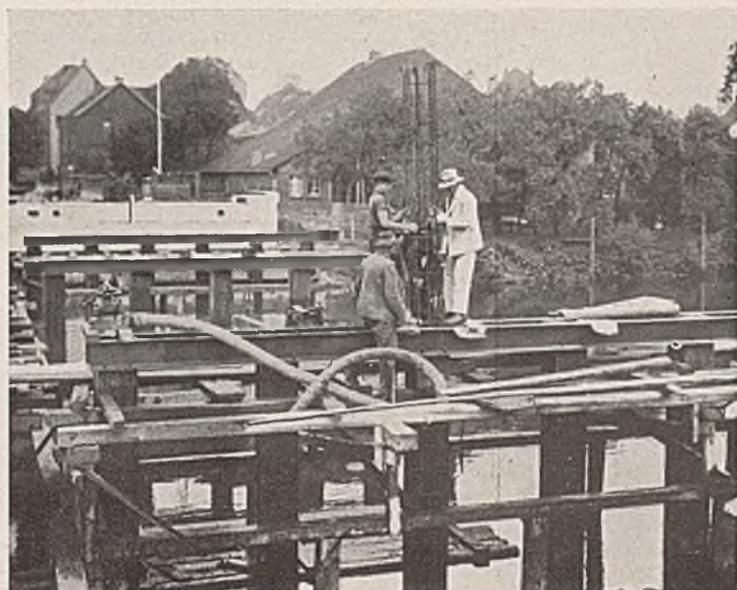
Das Innere der Krupp-Stahlpfähle wird mit eisenbewehrtem Beton ausgefüllt.
